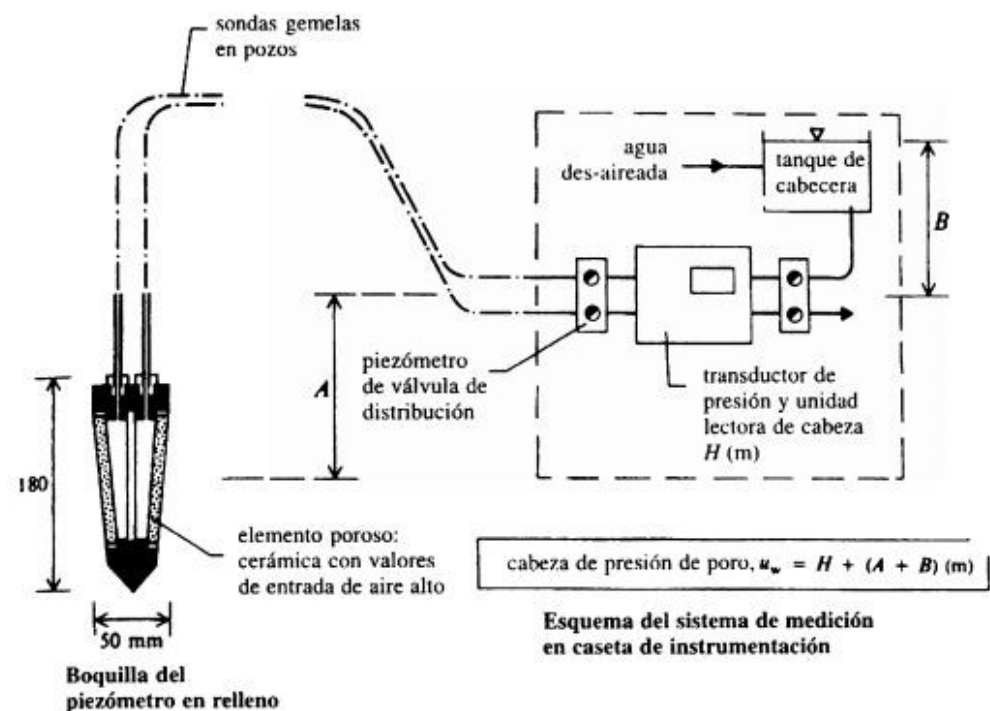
Piezómetro hidráulico de tipo Bishop de tubería gemela.
